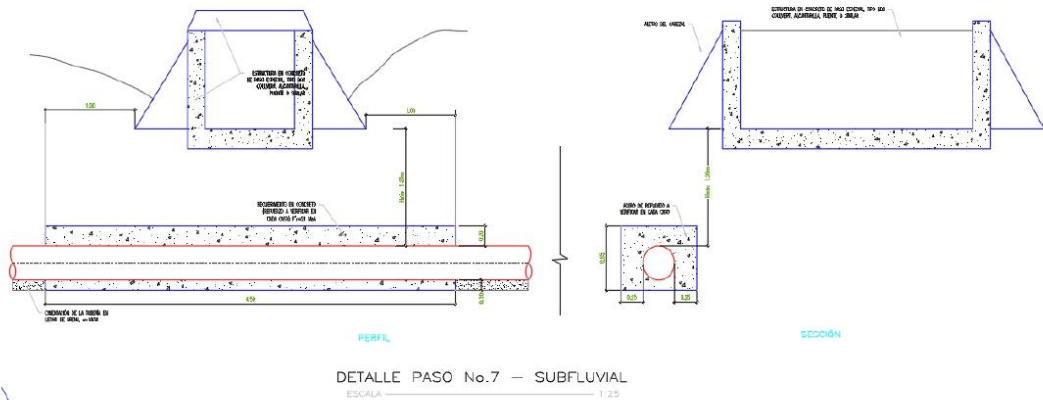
Detalle paso No.7. SUB-FLUVIAL
